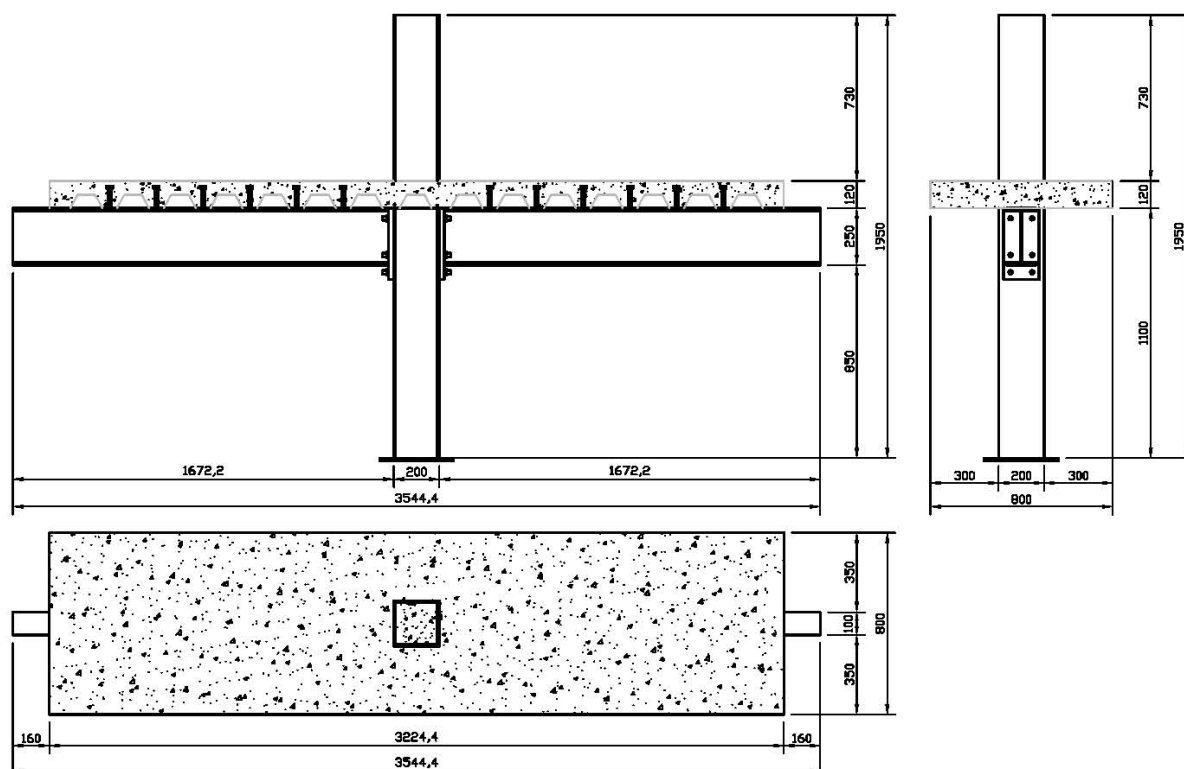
Dimensões dos modelos com laje (Unidade: milímetro).
